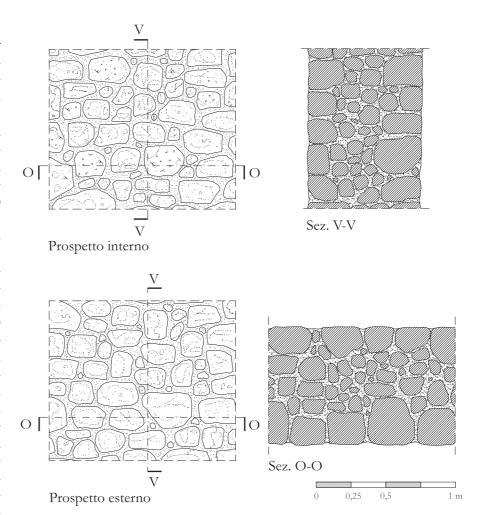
Dettaglio dell'apparecchiatura muraria dell'aula tricora in prospetto e sezione.
